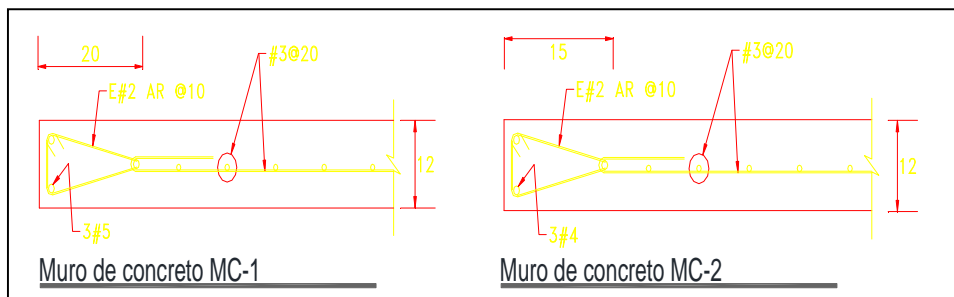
Armado de Muros de Concreto MC-1 y MC-2
